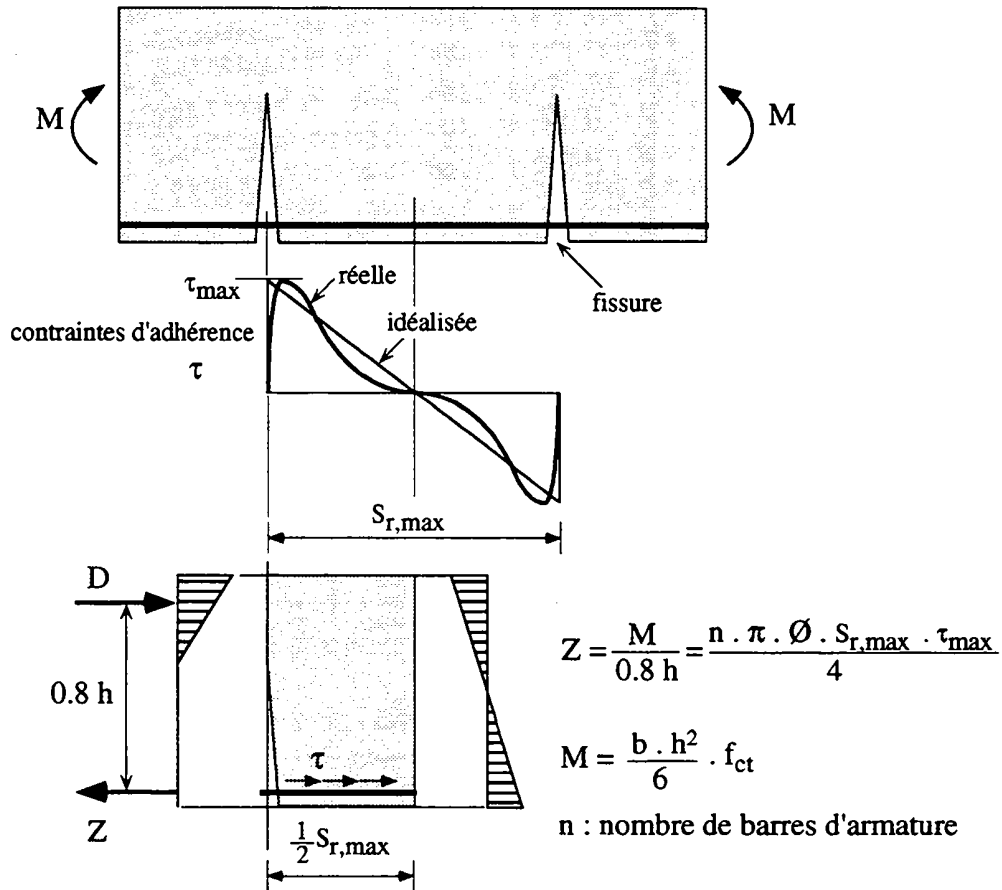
Mécanisme de transmission des forces par adhérence dans une poutre d'après Saliger[S1]
